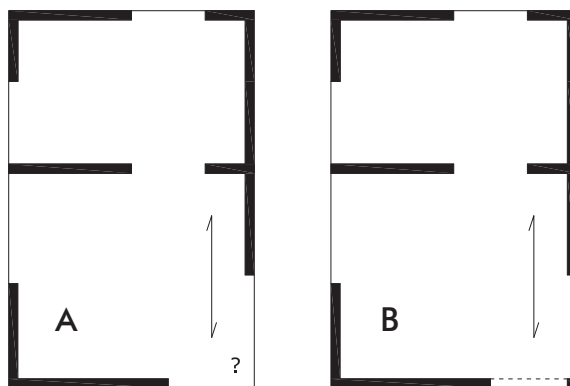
Disposizione in pianta dei solai. Nel caso A il solaio non trova appoggio nel punto "?";
